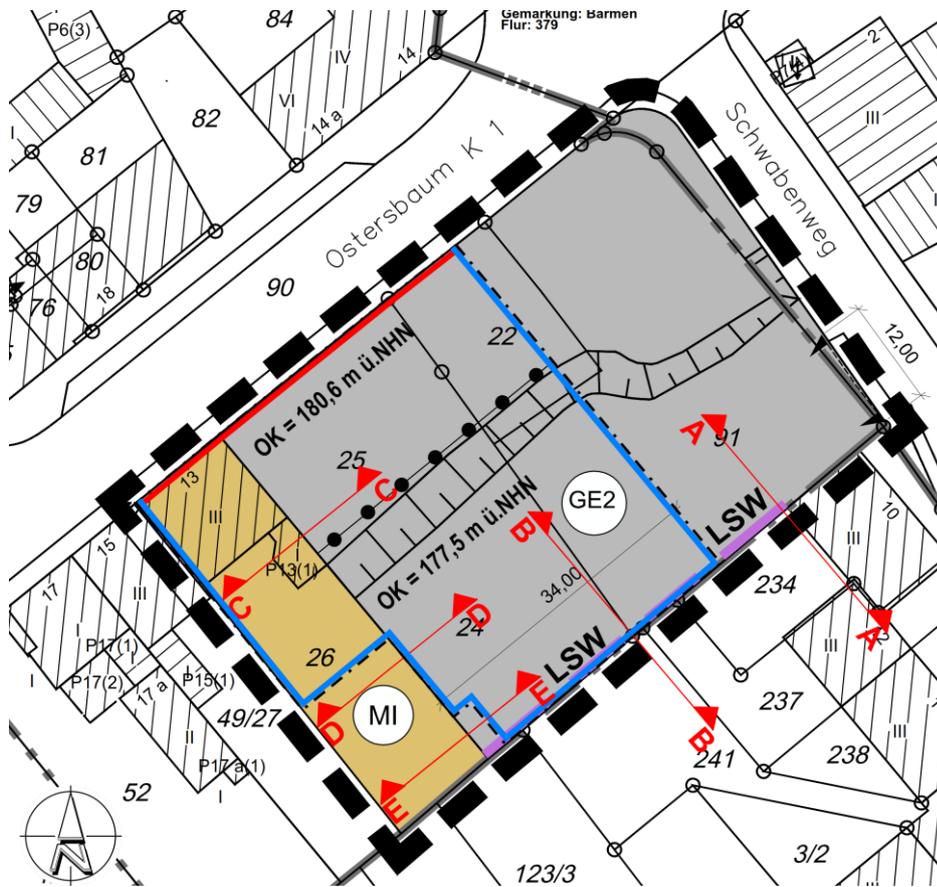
Lageplan mit Schnittlinien (unmaßstäblich)
